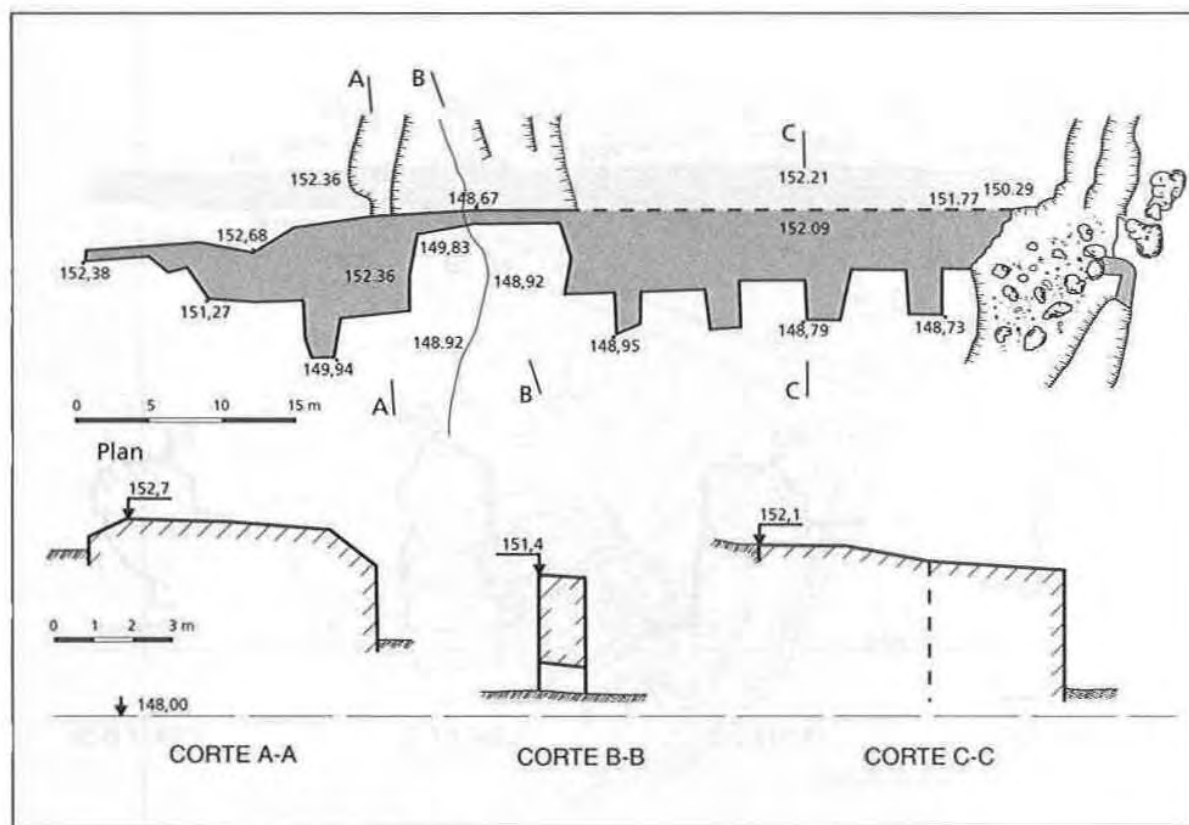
Barrage de Muro da Prega. Plan et coupes transversales.
